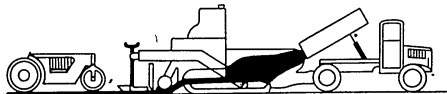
Kolejność robót przy budowie nawierzchni z betonu asfaltowego
